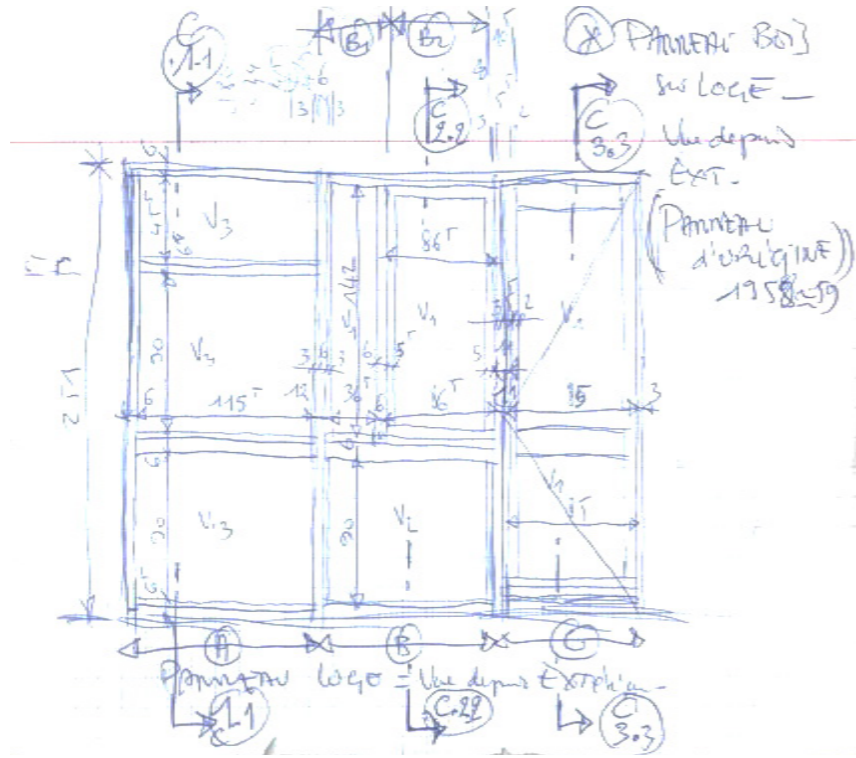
Façade intérieure loggia | Panneau d'origine type Z (relevés sur site).
